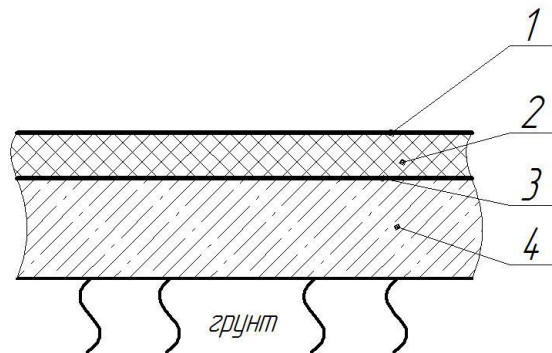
Переріз підлоги: 1, 3 – сталевий лист; 2 – утеплювач (пінопласт полістирольний ПСБ-С); 4 – залізобетонна плита; 5 – ґрунт
